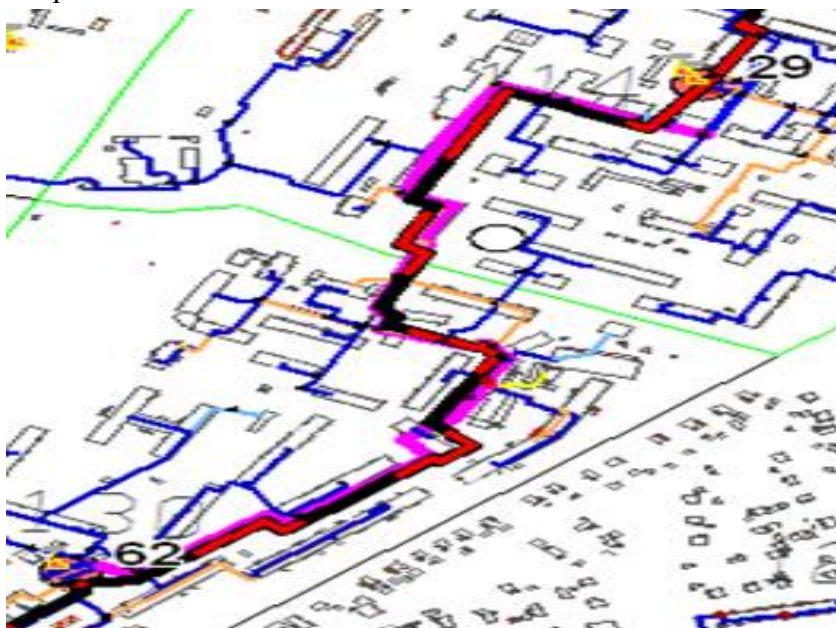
Схема прокладки трубопровода между котельными №62 и №29
